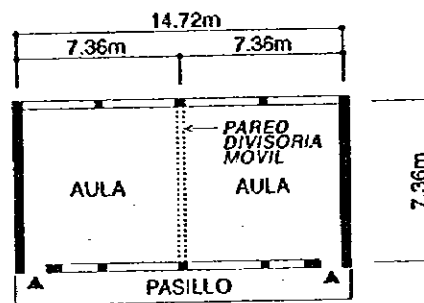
Plan superficial de edificio de tipo dos aulas con pared divisoria móvil
